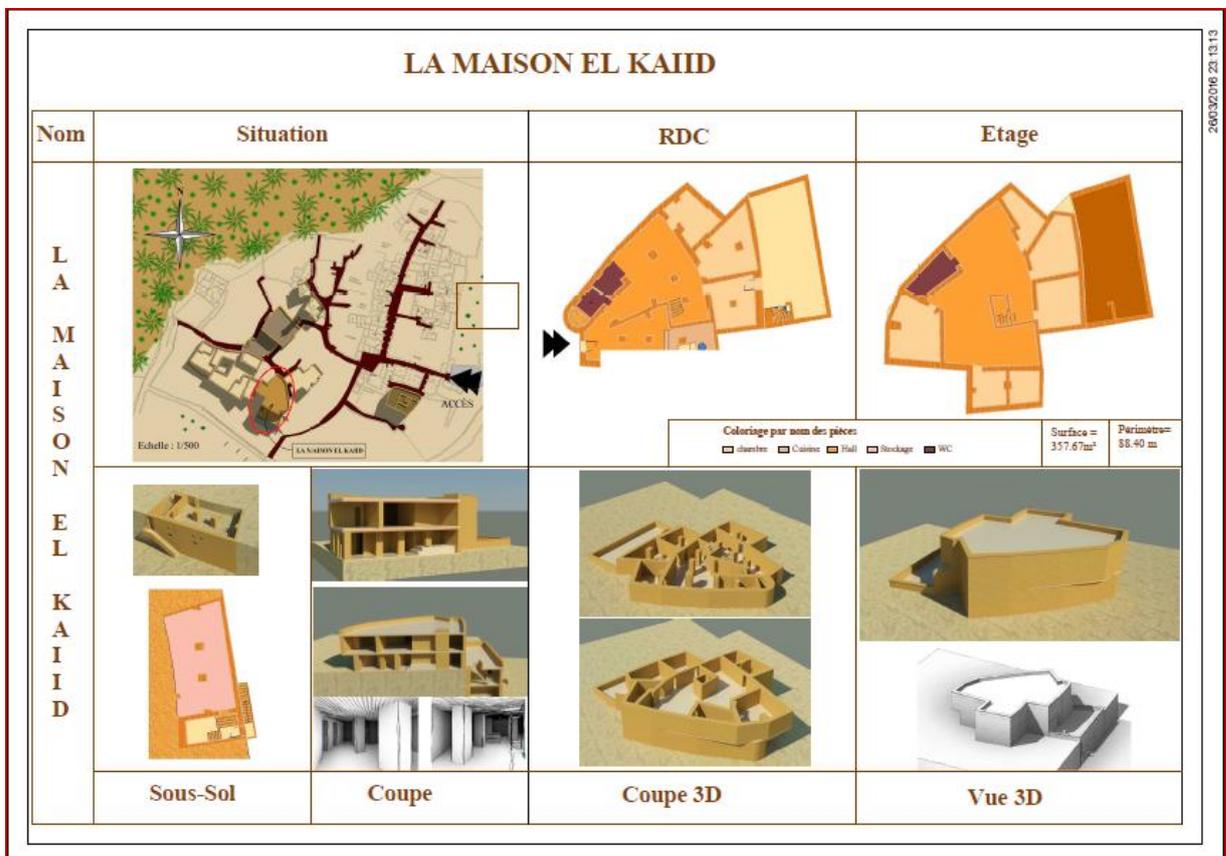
Plans architecturaux de la maison Kaid Ziane (Auteur, 2015)
